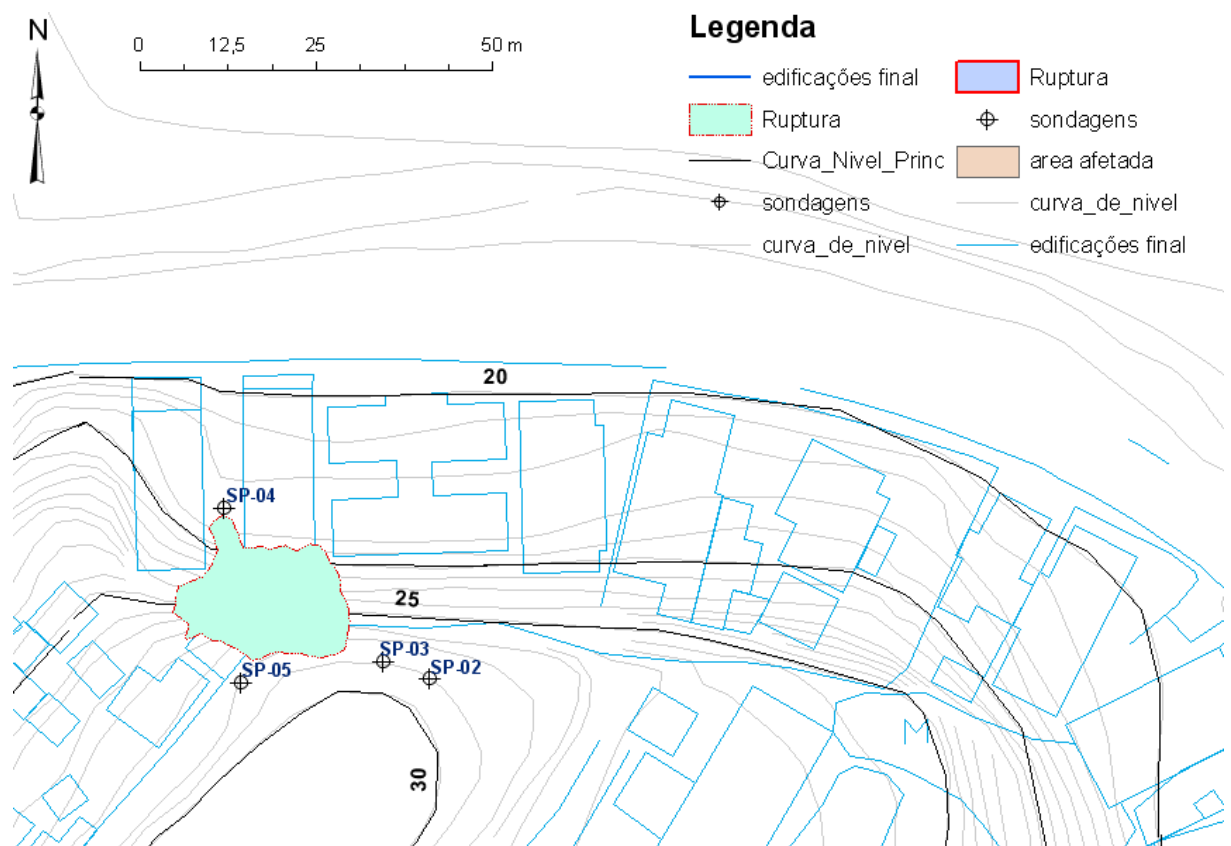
Levantamento planialtimétrico do morro do Gavazza.
